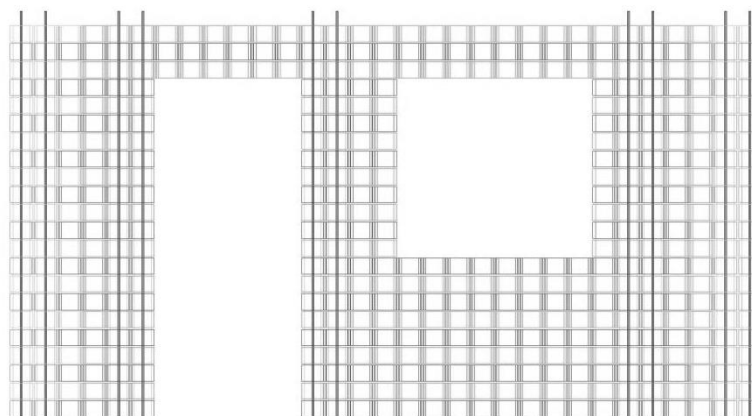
posizionamento delle armature per parete con porta e finestra
